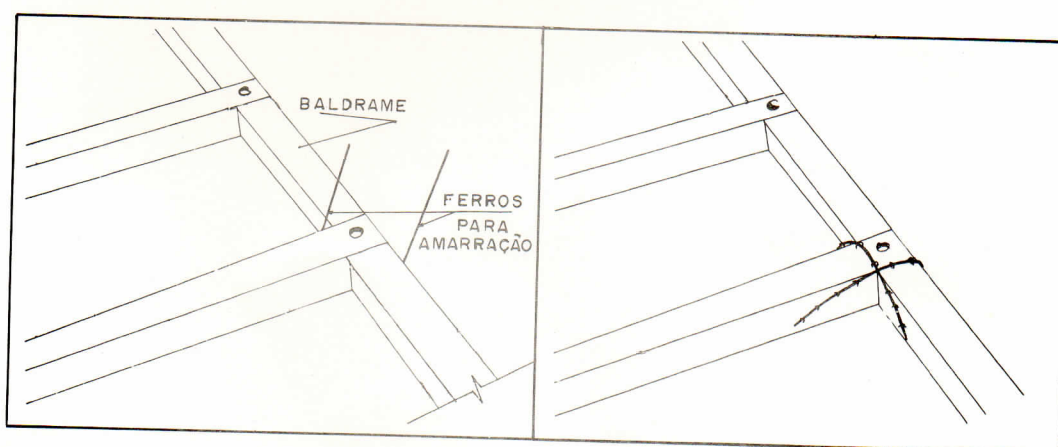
Amarração dos ferros no baldrame ou barrote.
